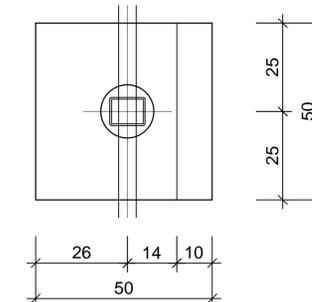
## Detail I - Betoninstandsetzung Einzelfundamente M1:10
